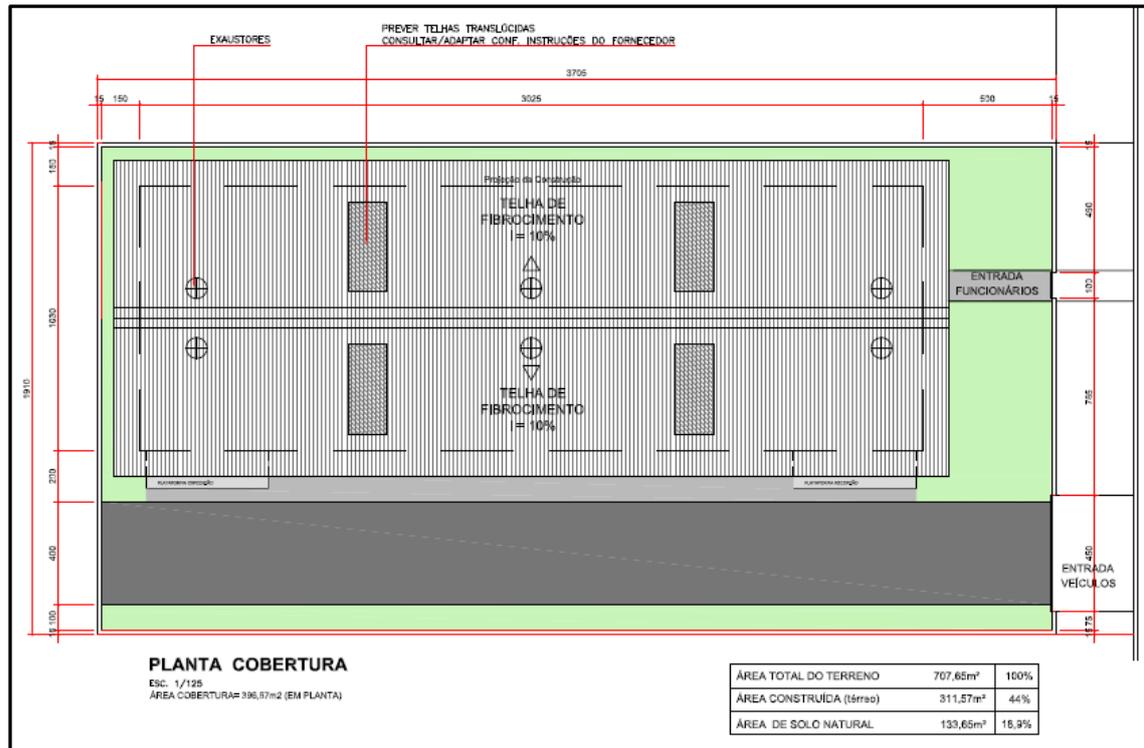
Implantação e Planta – Unidade de Triagem de Porte Pequeno. Elaboração: CARUSO JR., 2013.
